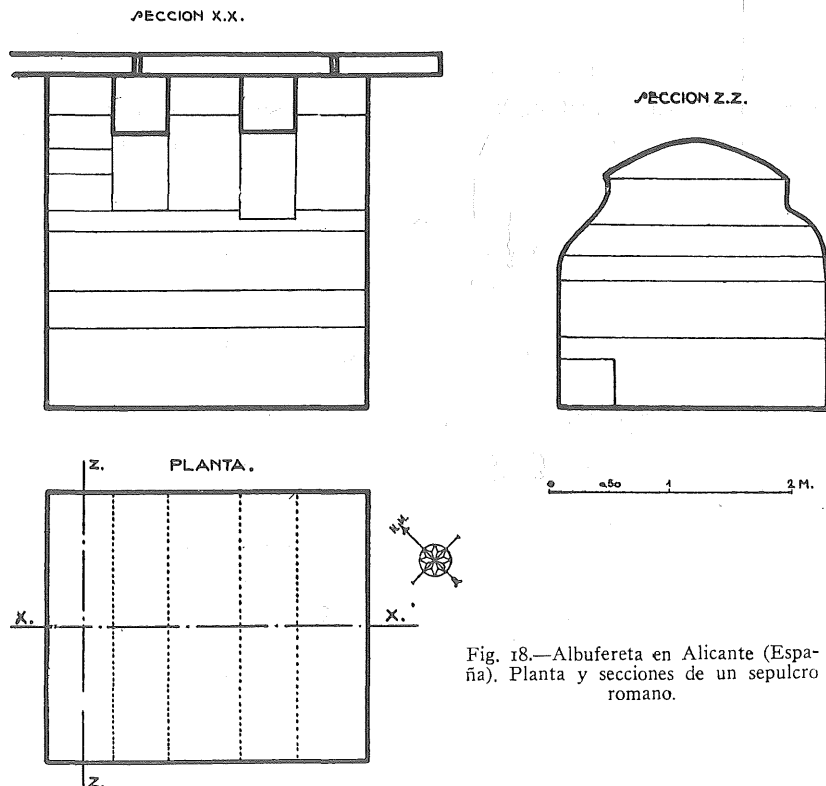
Albufereta en Alicante (España). Planta y secciones de un sepulcro romano.
